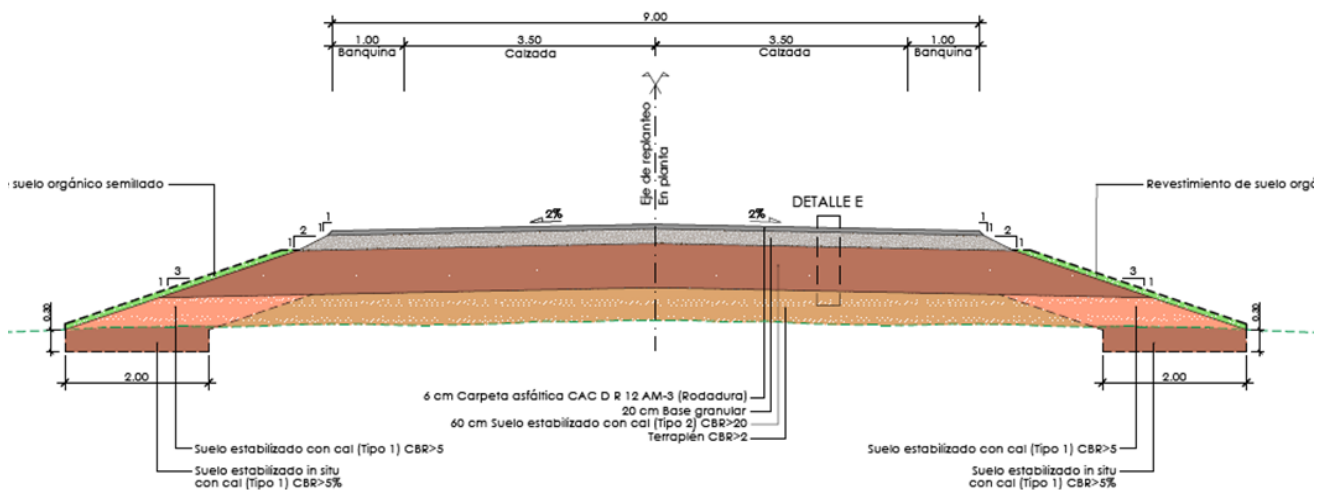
Sección tipo de obra básica y estructura de pavimento, Ninfa
